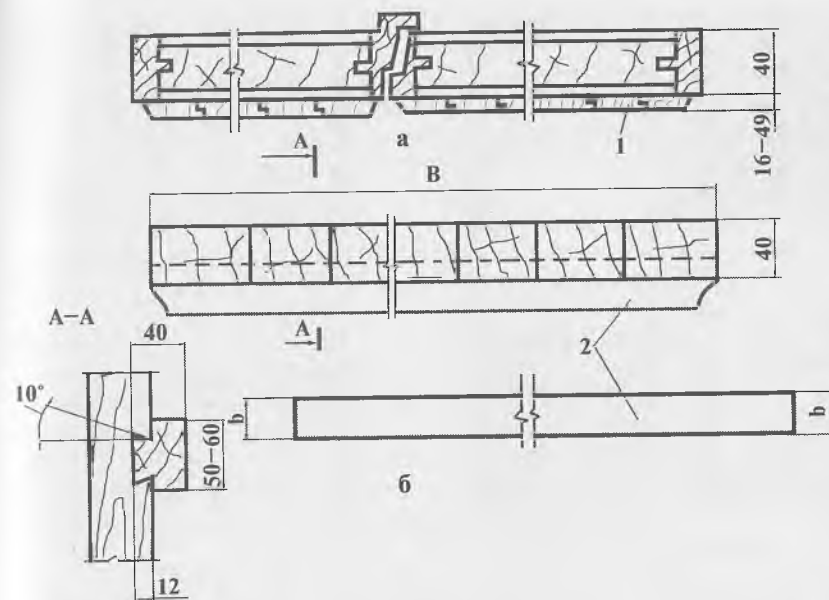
Сечения деталей глухих полотен наружных дверей:
